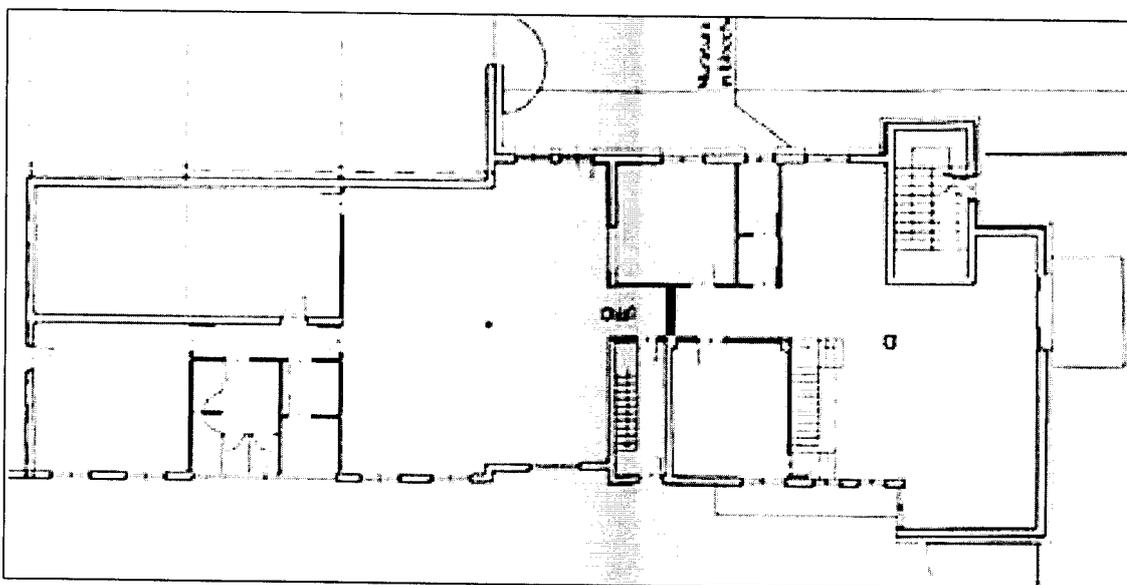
Estratto planimetria C.E. 8.11.1995 – P.T. capannone (porzione uffici)
